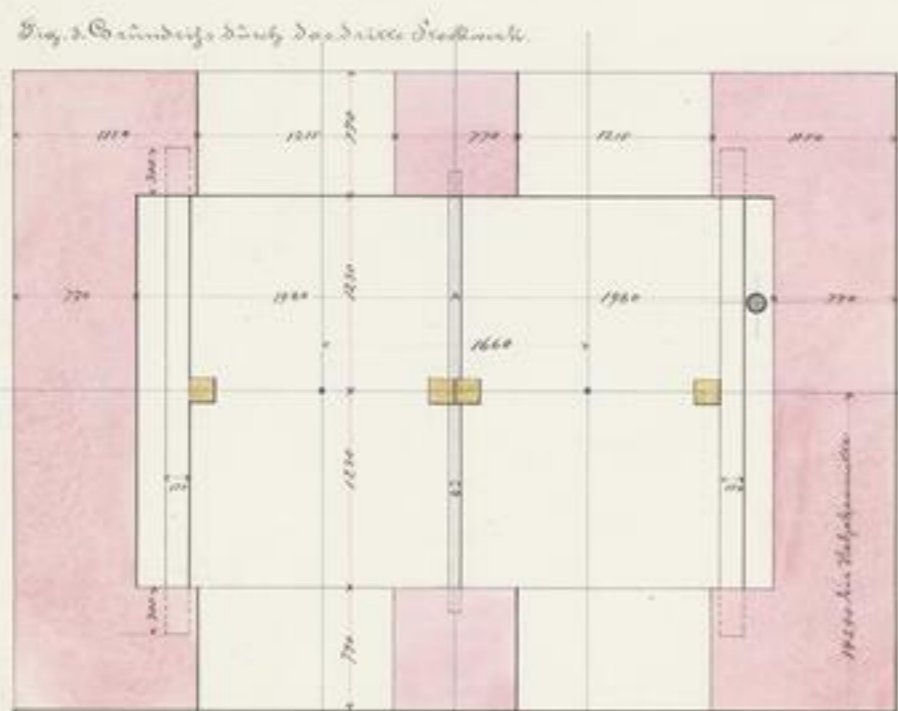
Grundriss durch das alte Streckwerk.
